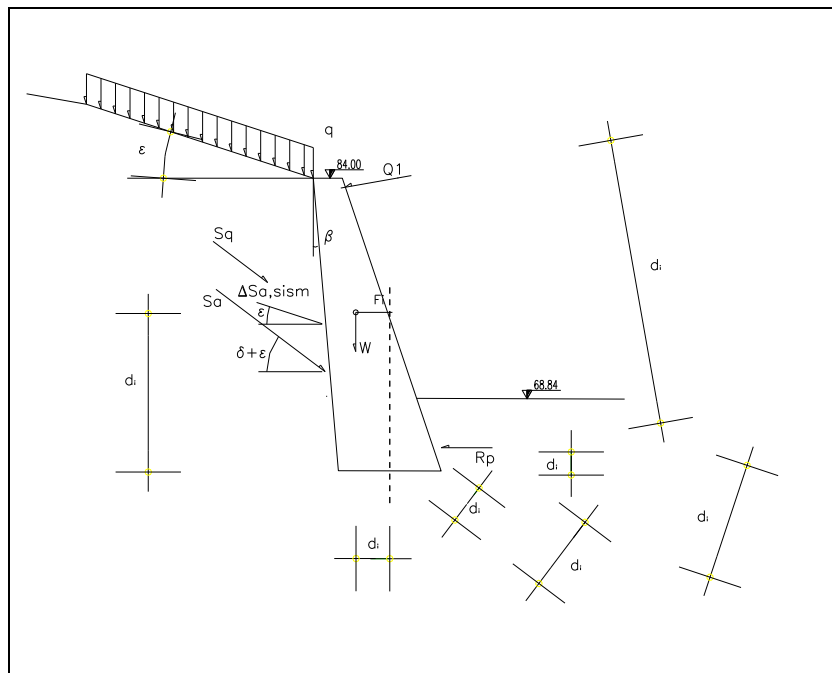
Schema di calcolo con indicazione delle forze agenti e dei rispettivi bracci rispetto alla sezione di verifica – caso sismico
